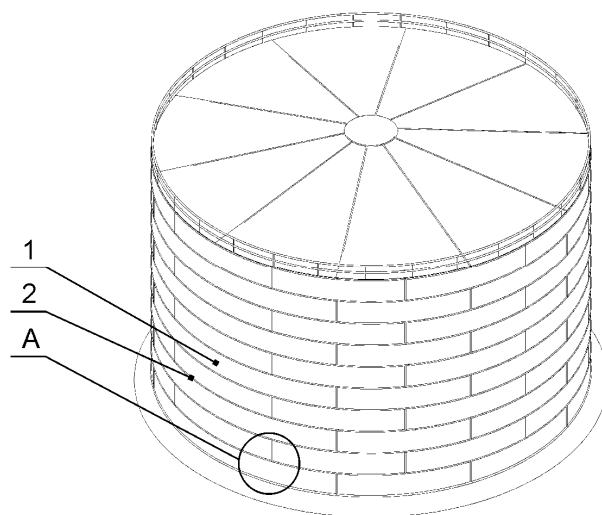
Изометрический вид типового вертикального цилиндрического резервуара
